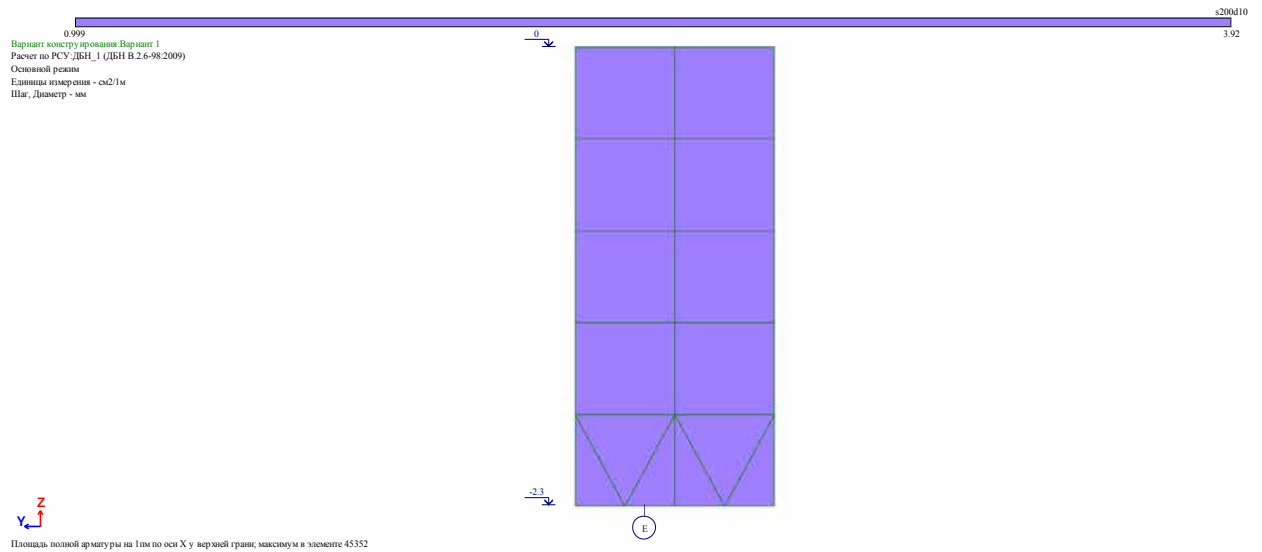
Площадь арматуры вдоль глобальной оси X
